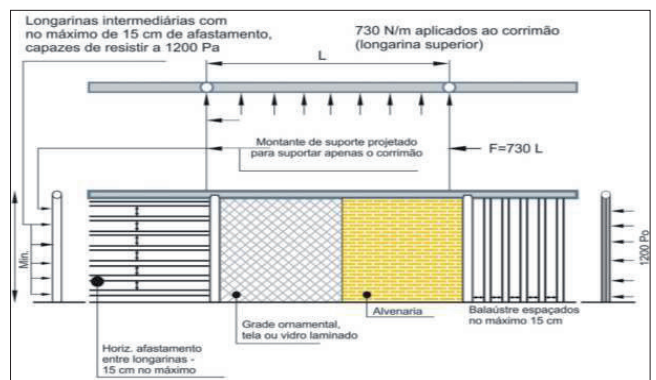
Pormenores construtivos da instalação de guardas e as cargas a que elas devem resistir
